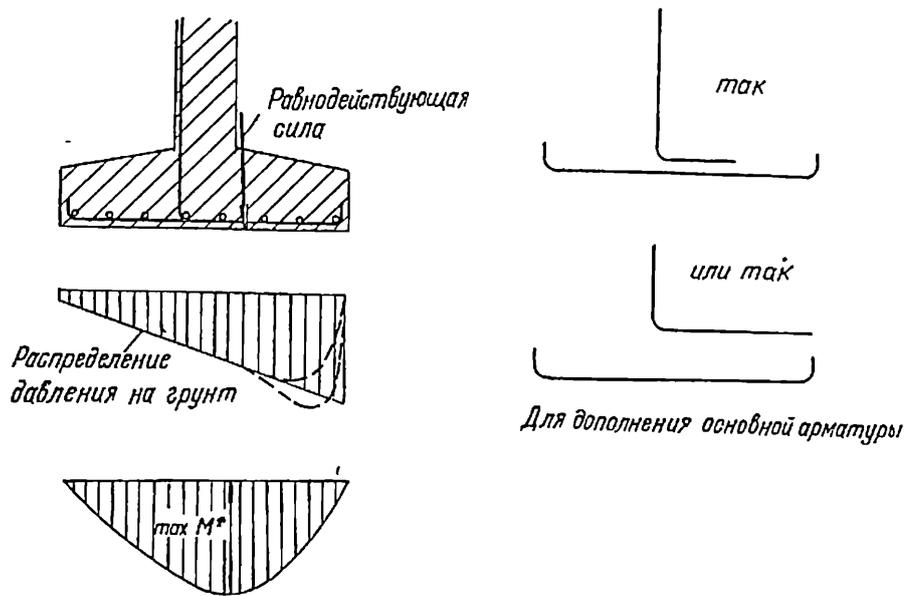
6. При внецентренной нагрузке растянутая арматура из стены отгибается в сторону равнодействующей
